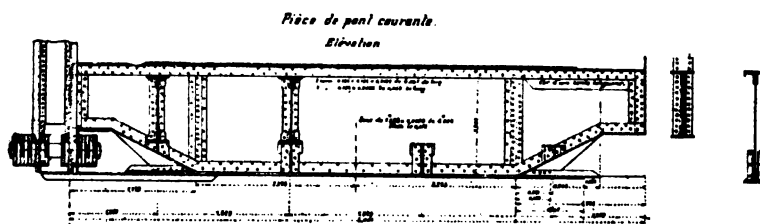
Pont de Hawkesbury. Attaches du tablier.
